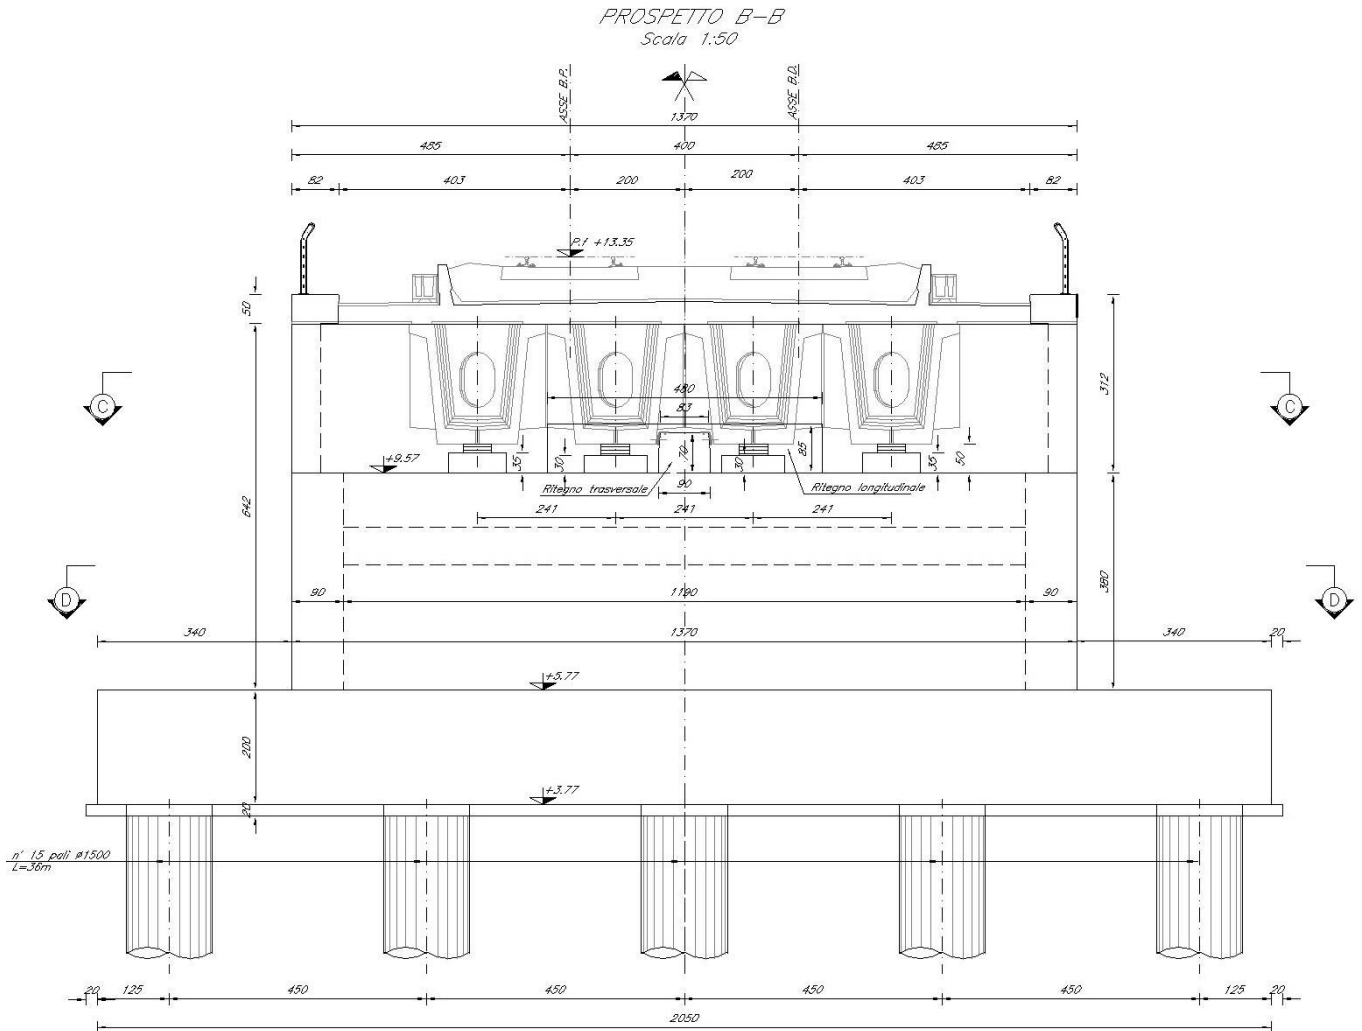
Sezione longitudinale spalla SPA
